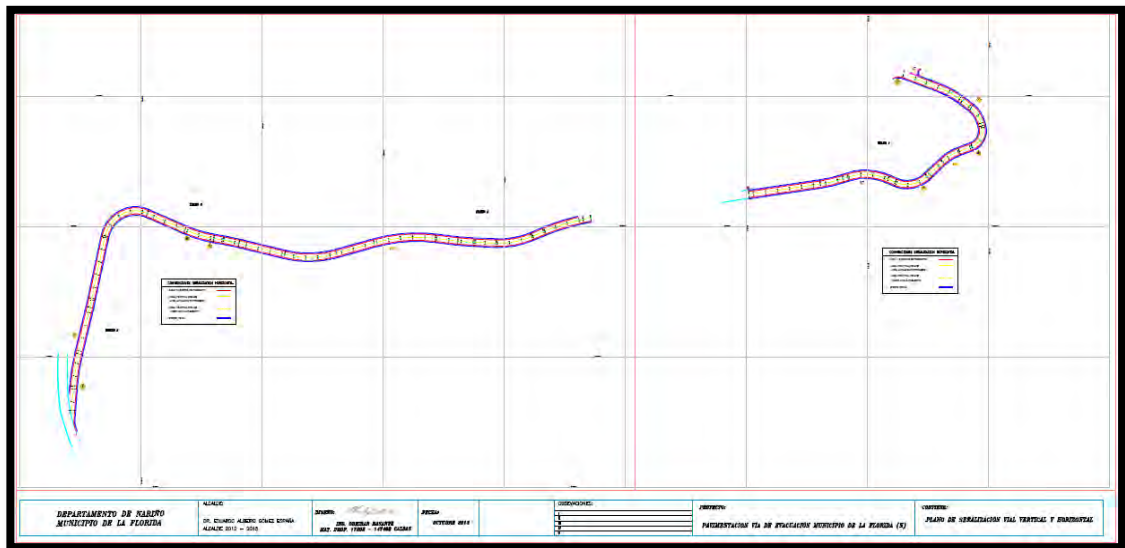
Plano de tramo 1 y 2 de la vía a pavimentar.
